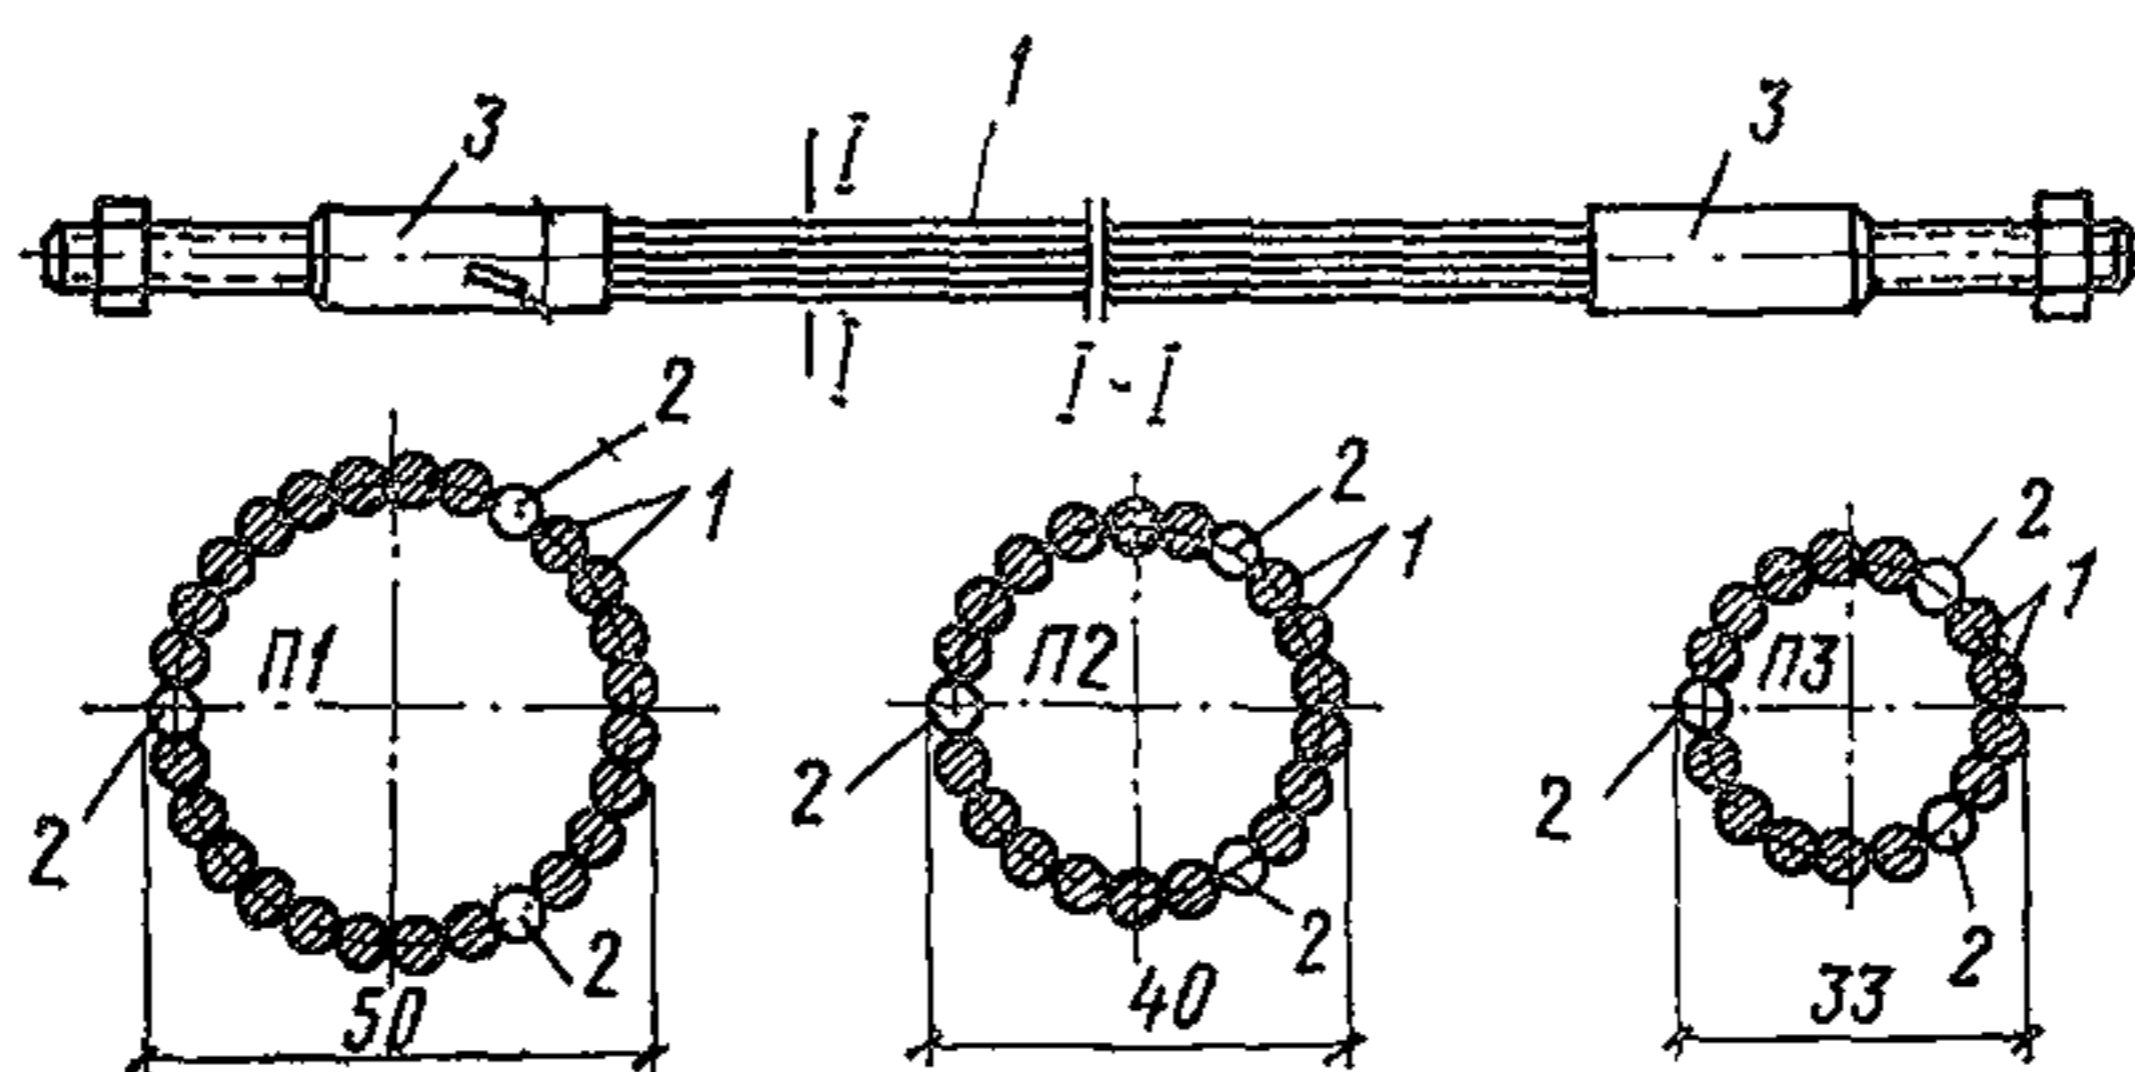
Арматурный элемент с гильзостержневыми анкерами
